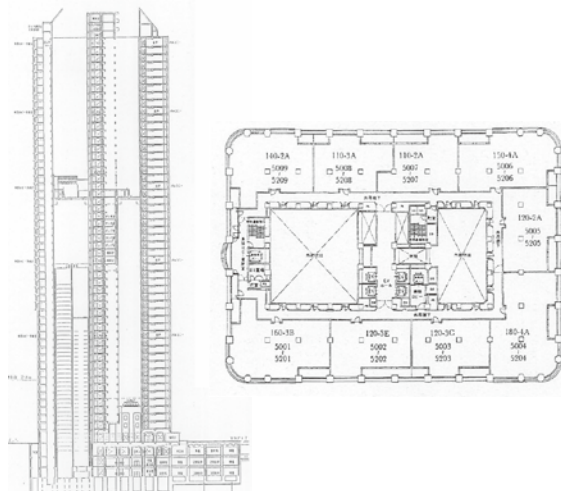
類型Ⅱ センチュリーパークタワー 平面図・断面図
